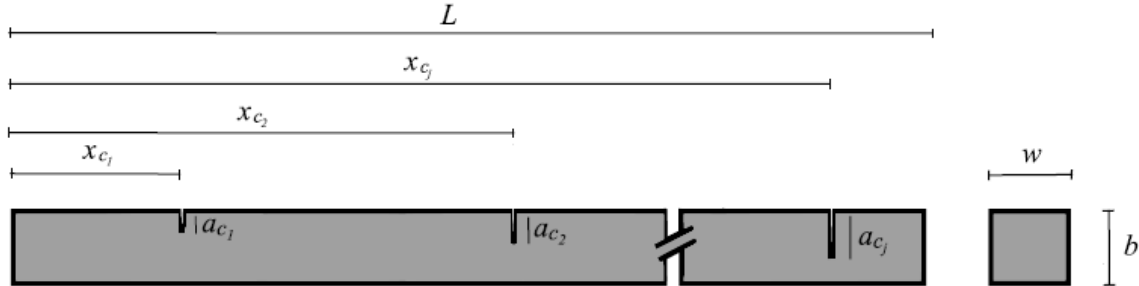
Elemento de viga com múltiplas trincas (Christides e Barr, 1984).
